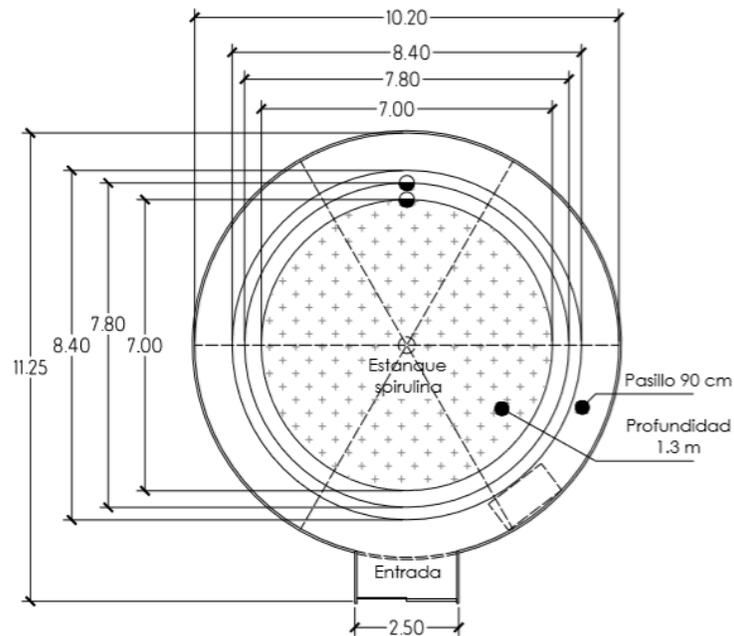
Planta Arquitectónica Invernadero. Fuente: Elaboración propia mediante levantamiento.
